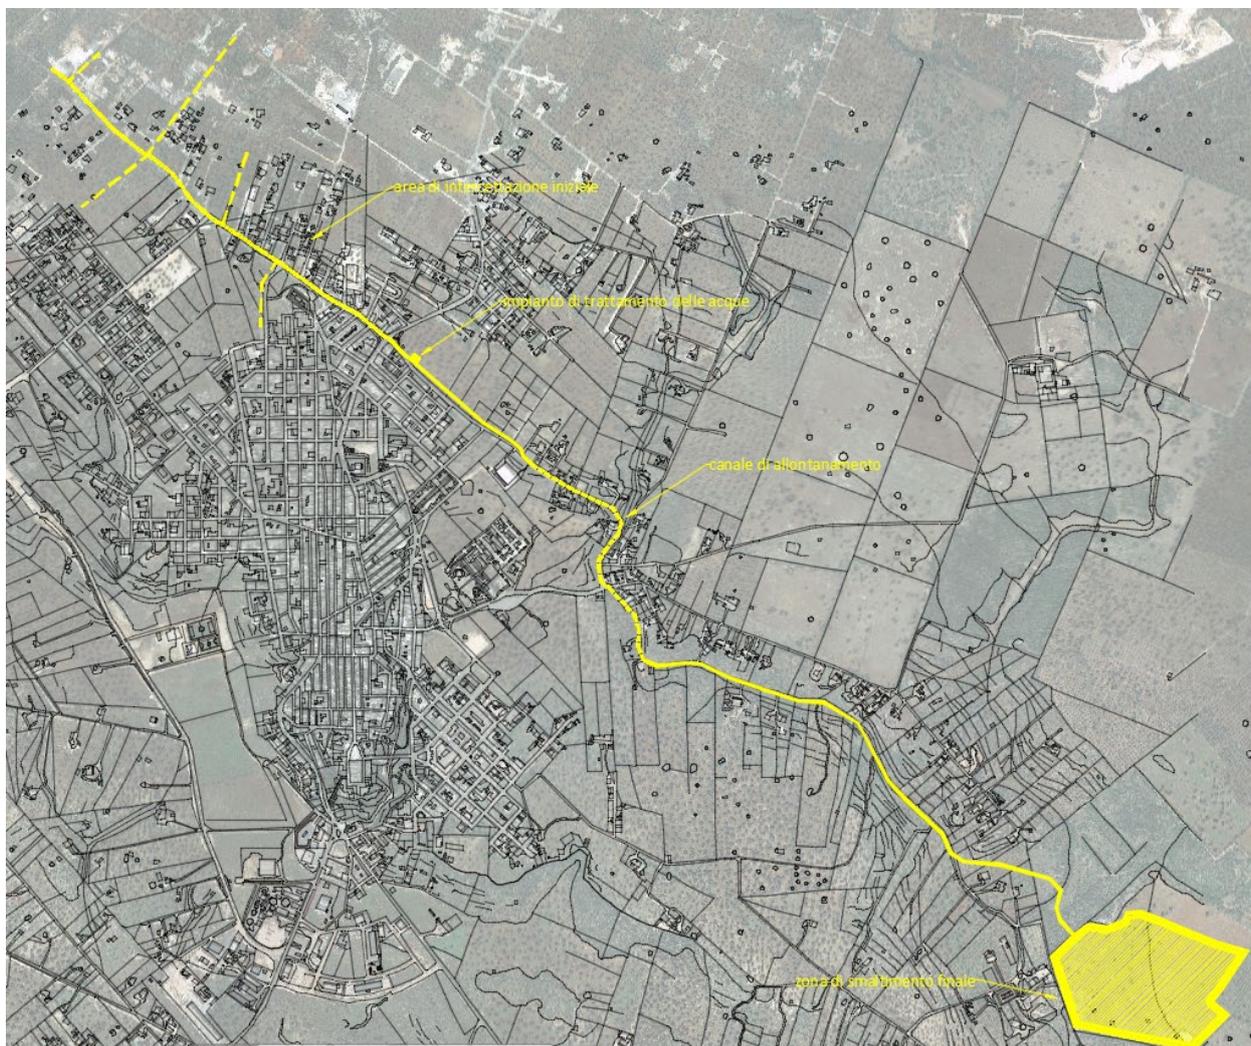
Planimetria della soluzione progettuale scelta
